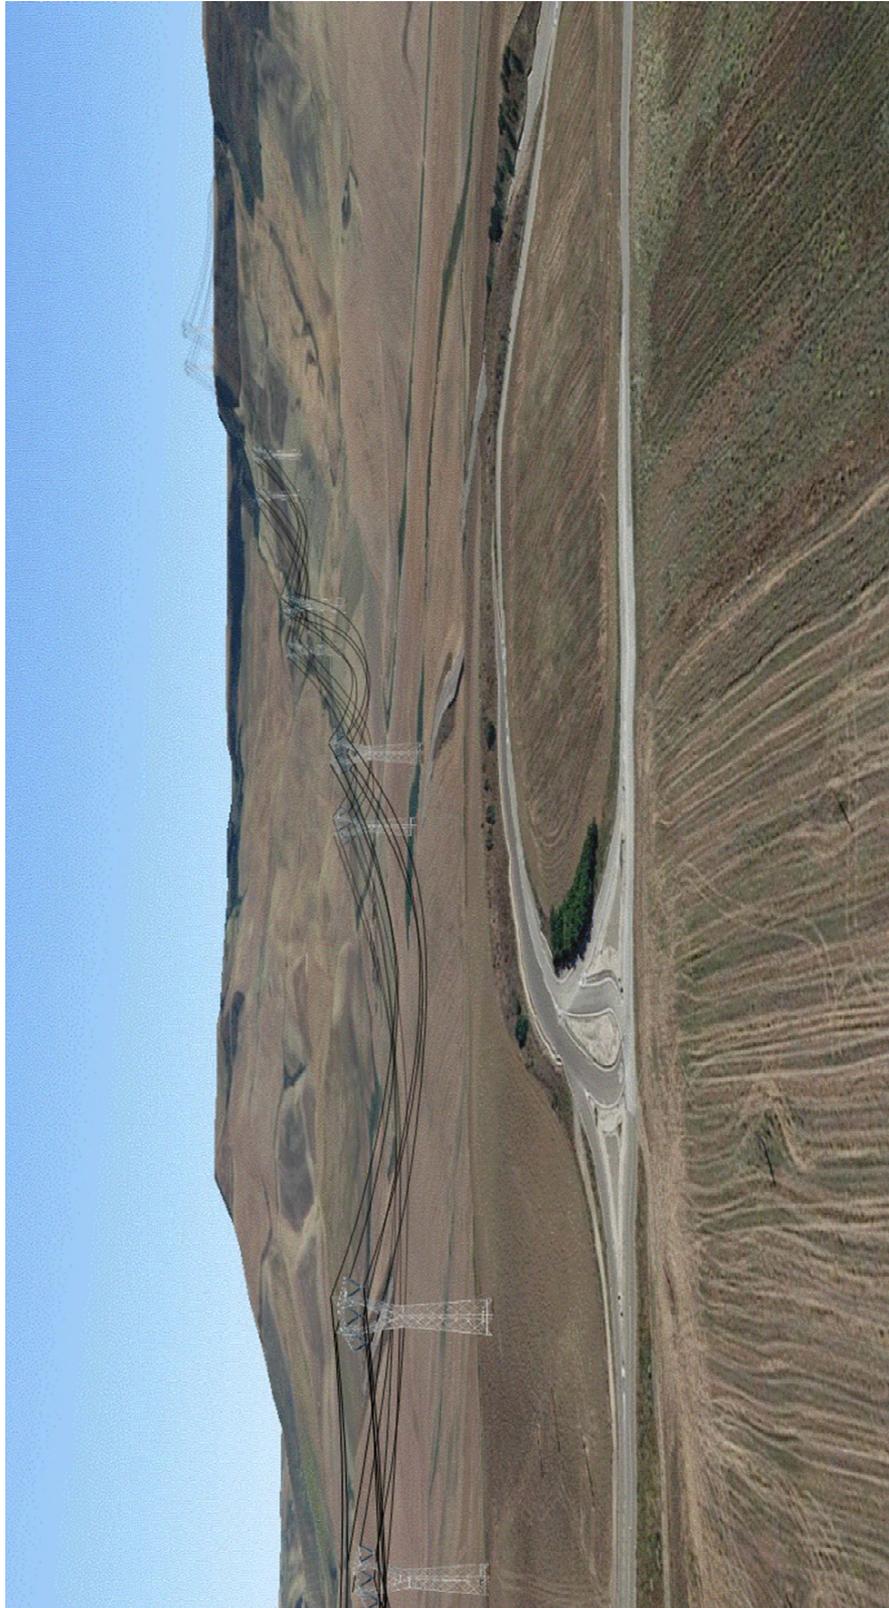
Vista prospettica del nuovo elettrodotta aereo dalla SS96.
